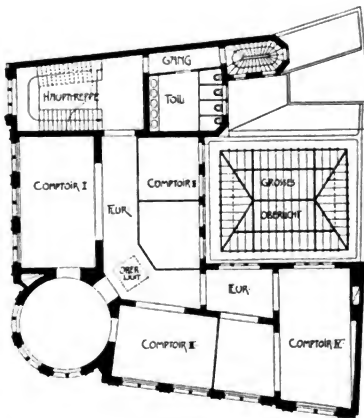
Grundrisse der Nationalbank. I. Obergeschoss.
